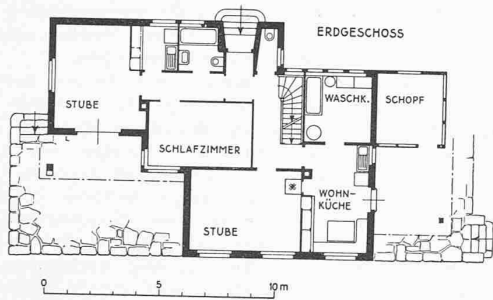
Typ A, Grundrisse 1 : 300
